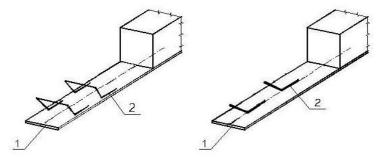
Die biegsamen Stahlbetonelemente mit der äußerlichen Blattbewehrung: 1 – das Stahlstützblatt; 2 – der Anker
